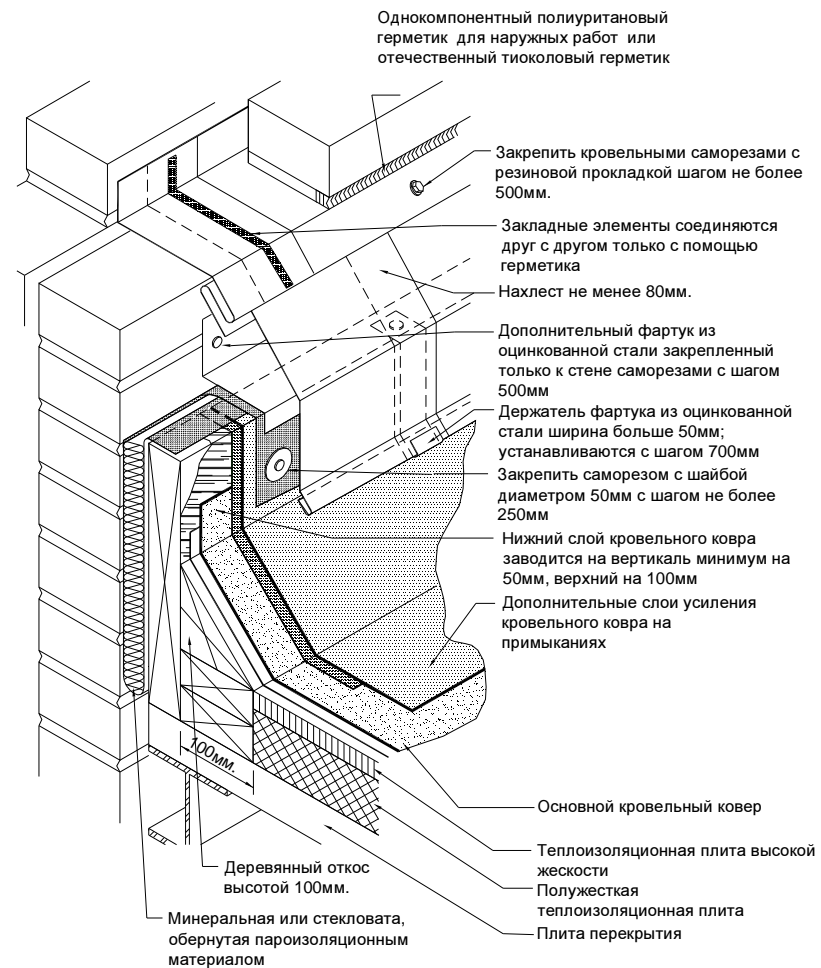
Деформационный шов в примыкании кровли к стене.
